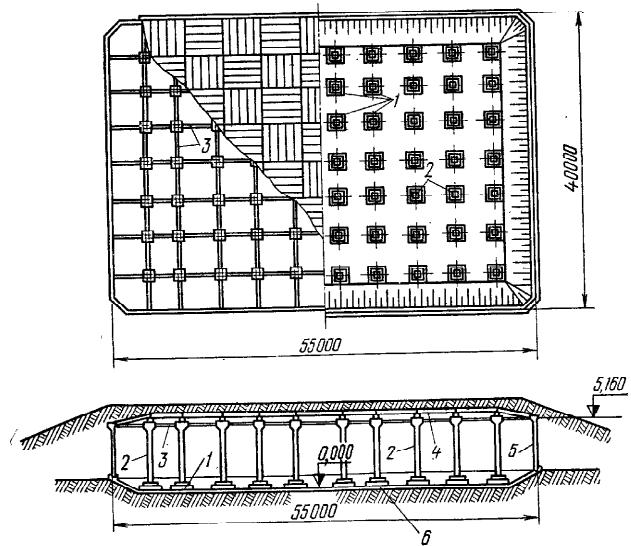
Прямоугольный резервуар из сборных железобетонных элементов:
